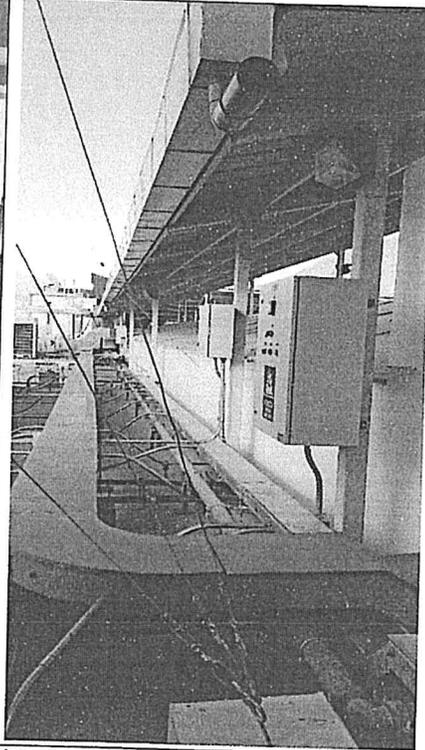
Se advierte que la tubería de drenaje fluvial desemboca cerca al tablero eléctrico.
